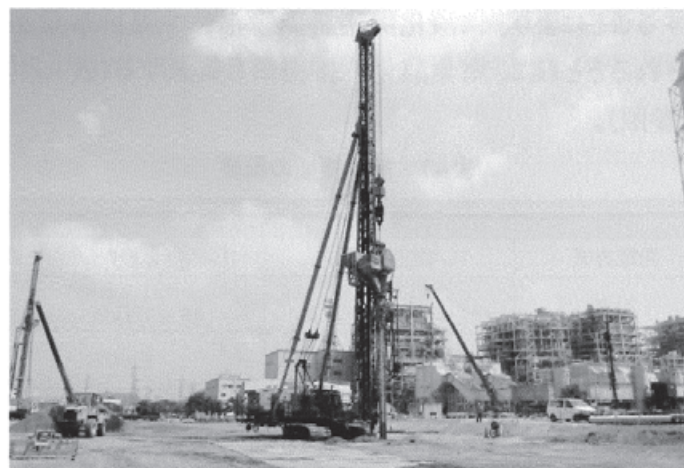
サンドコンパクションパイル工法の施工状況（事例シート2-10）
